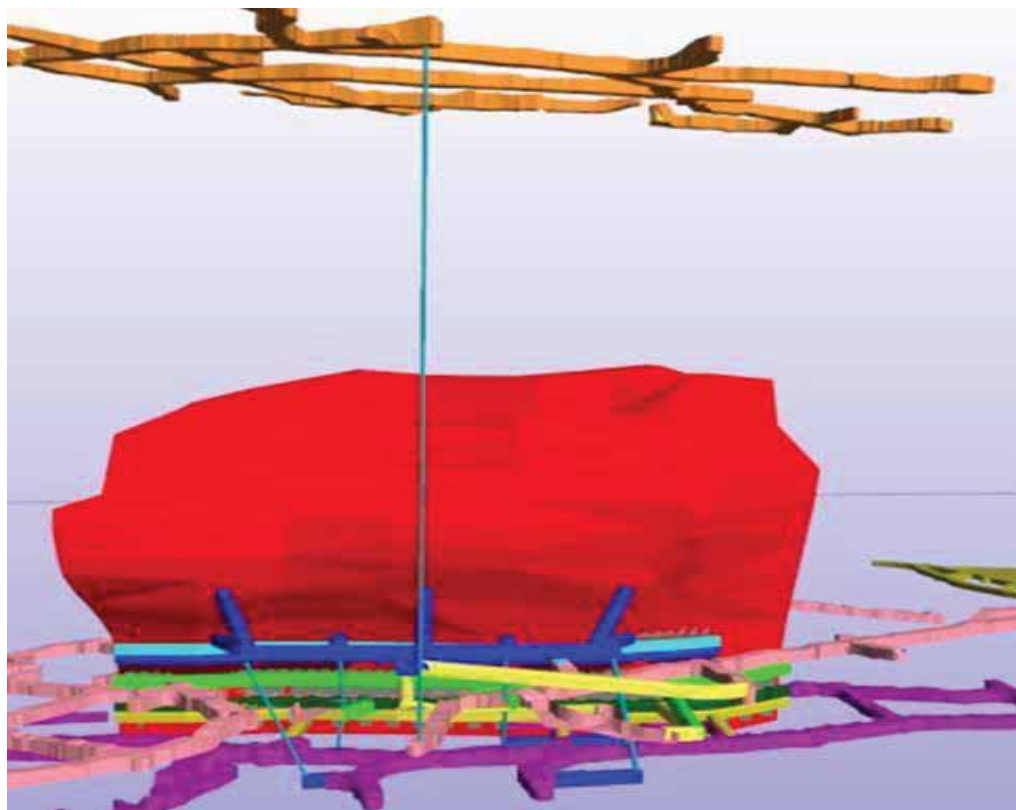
Minado de la segunda fase (vista de frente). Fuente: Archivo del área de Ingeniería, planeamiento y proyectos - PASHSA.
